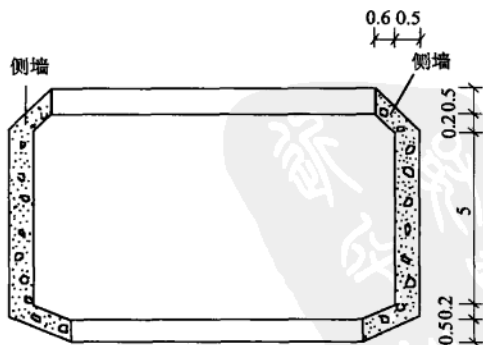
预制沉管混凝土侧墙示意图 (单位:m)
